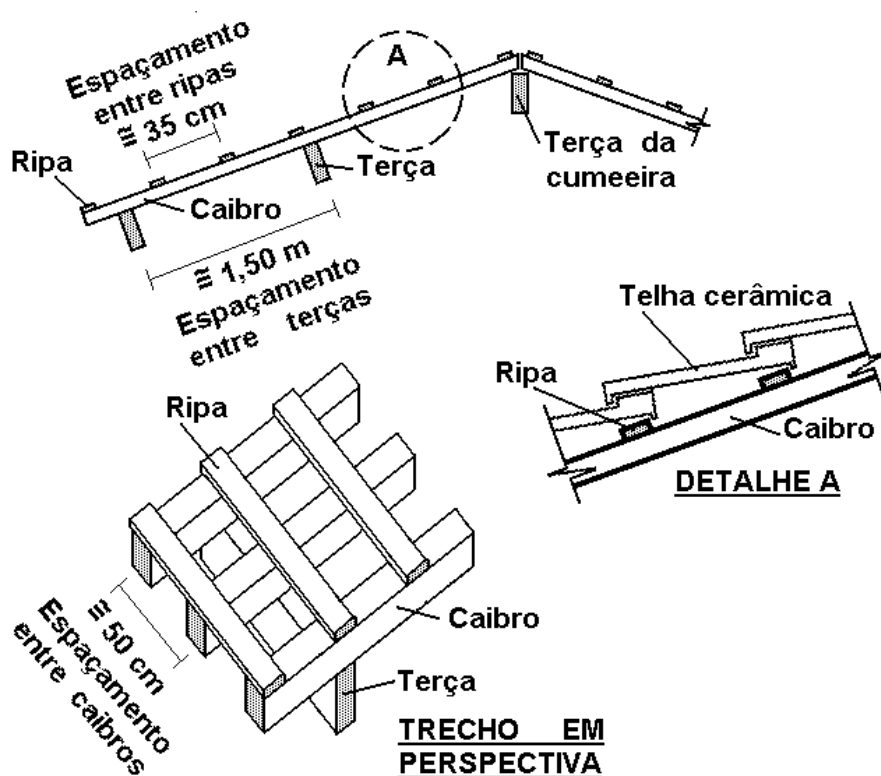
Trama de um telhado convencional com telhas cerâmicas
